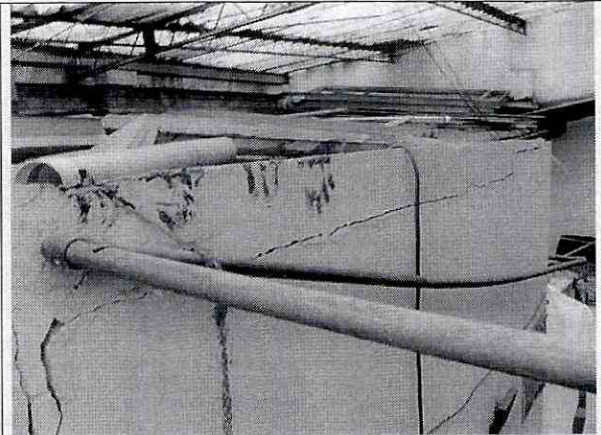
Detalle de la separación entre losa superior de concreto y muros de mampostería.
